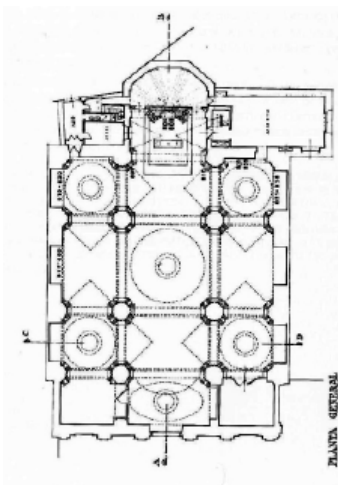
Zaragoza. Iglesia de Santa Isabel. Planta. Autor: José María Valero Suárez.
